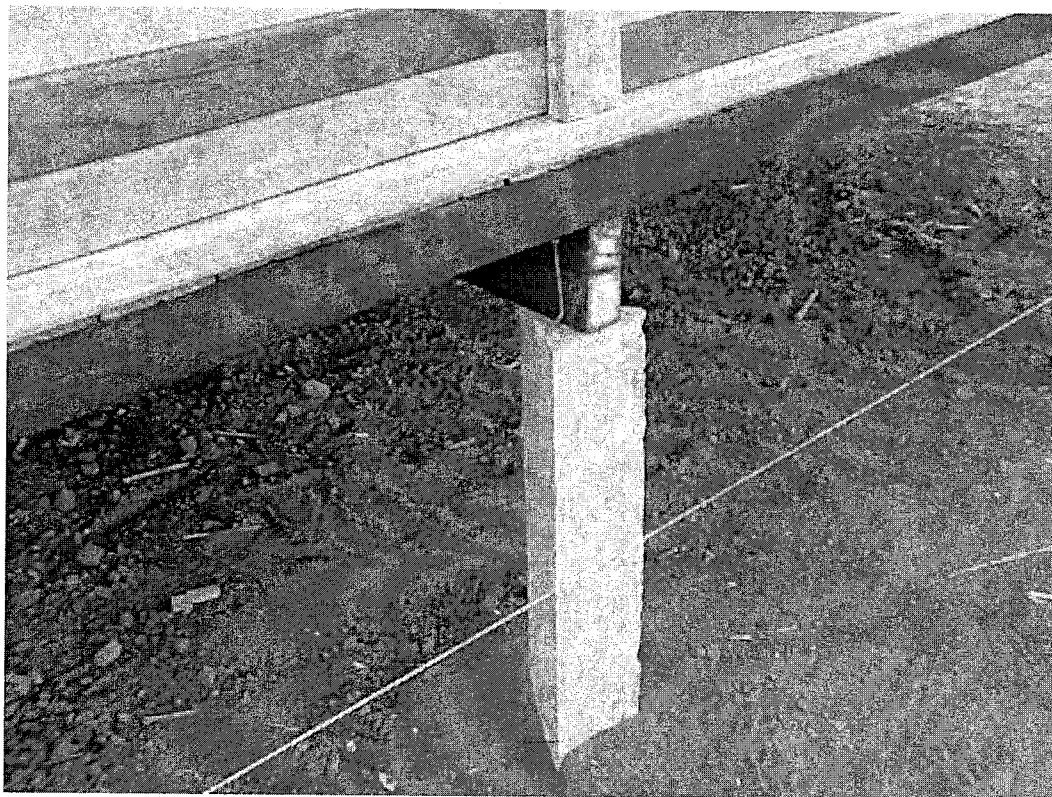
Detalhe do barrote em concreto armado – seção triangular.
